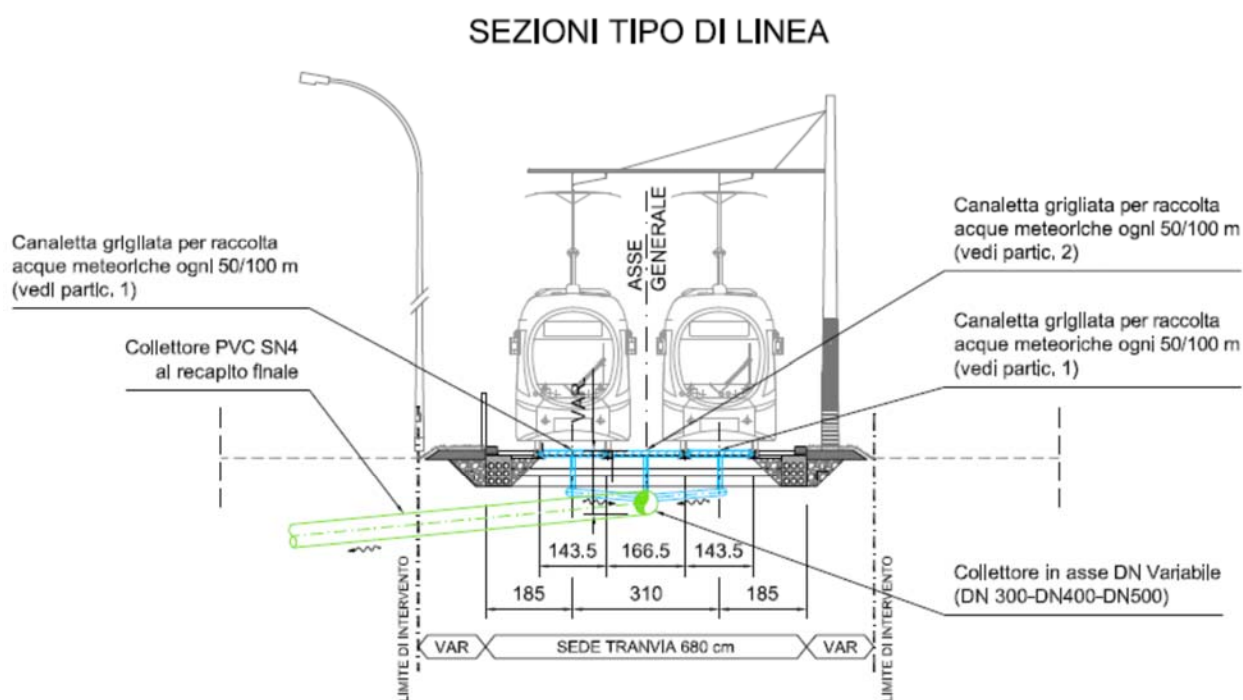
Collettamento acque meteoriche - Sezione tipo di linea su nuova pavimentazione
